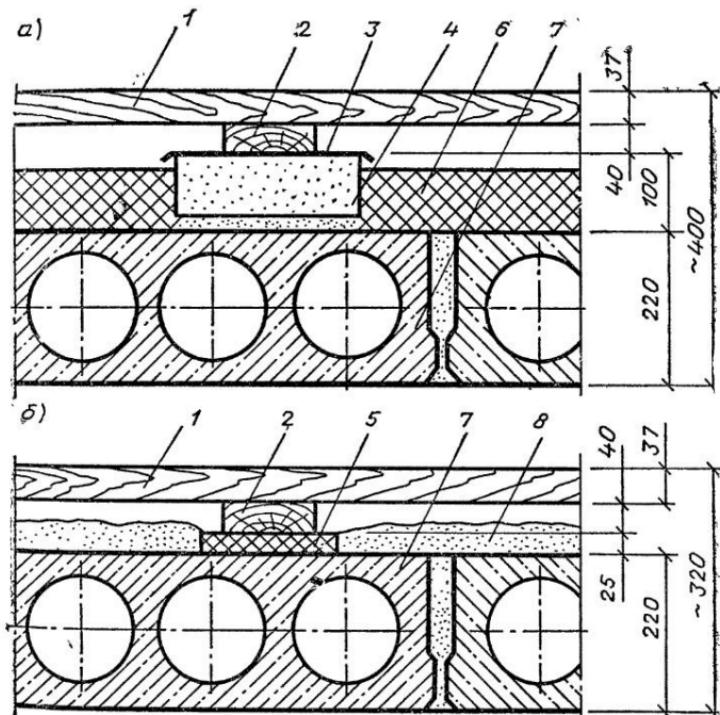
Дощатый пол на железобетонном перекрытии
